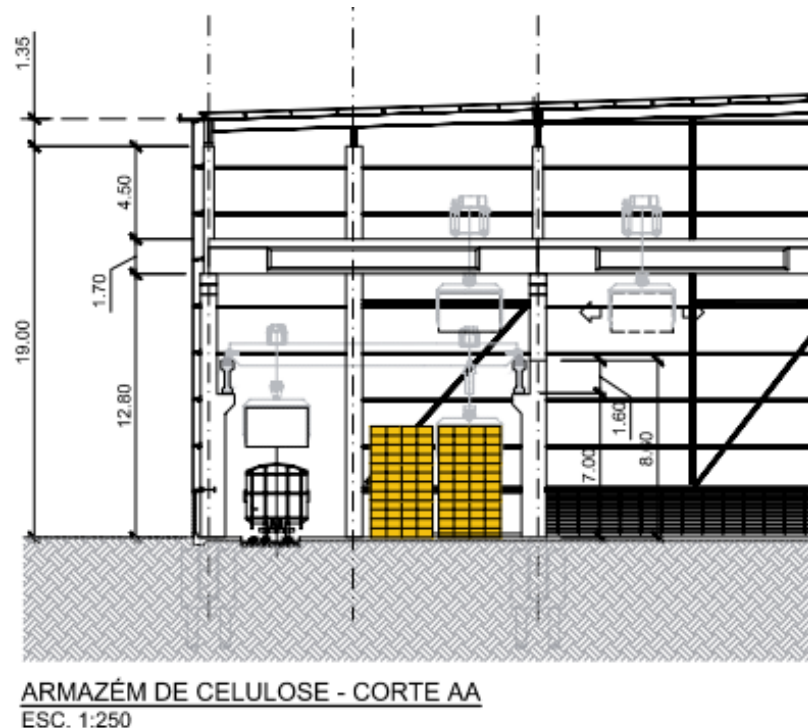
Corte típico da área de descarga ferroviária. Fonte: Pöyry, 2018.
